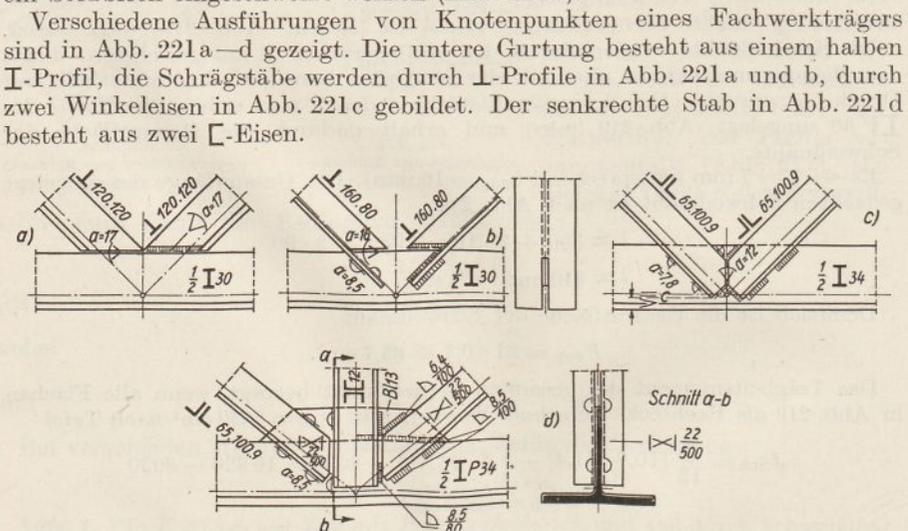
a—d. Geschweißte Knotenpunkte von Fachwerkträgern.
